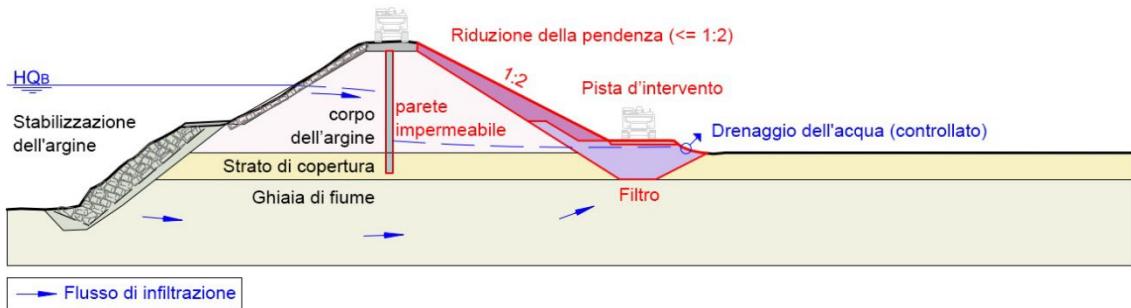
Sezione trasversale tipica di un argine nel caso di risanamento con una parete impermeabile (strato filtrante in viola).
